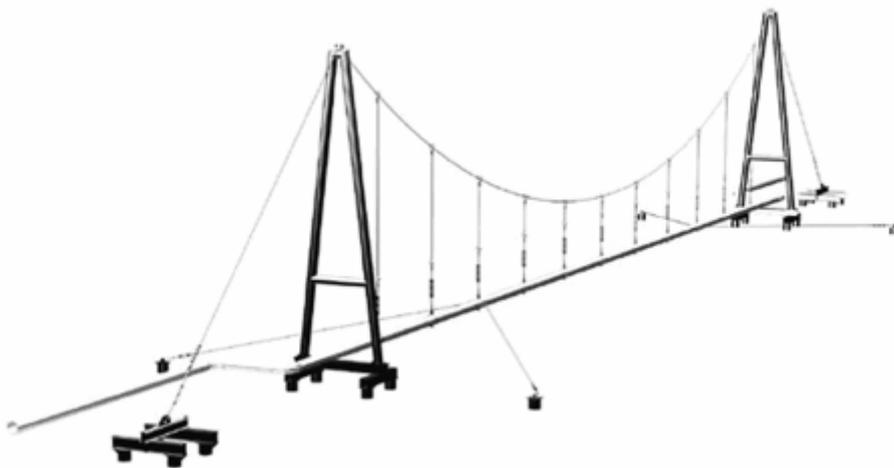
Подвесной вантовый переход надземного трубопровода РЗ–25 (52–НЦ/3–03–АС)
